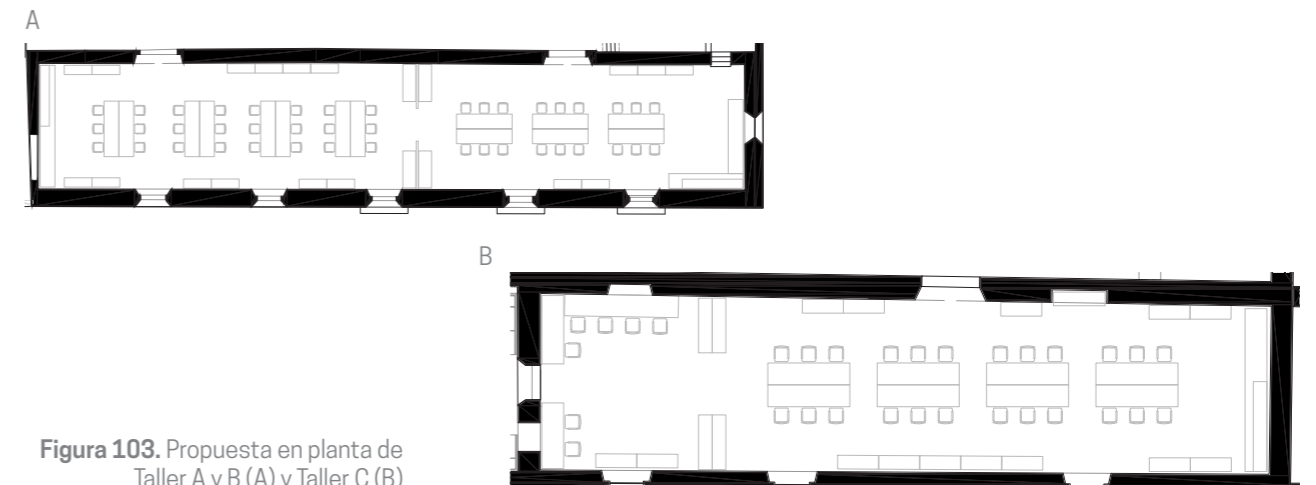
Propuesta en planta de Taller A y B (A) y Taller C (B)
